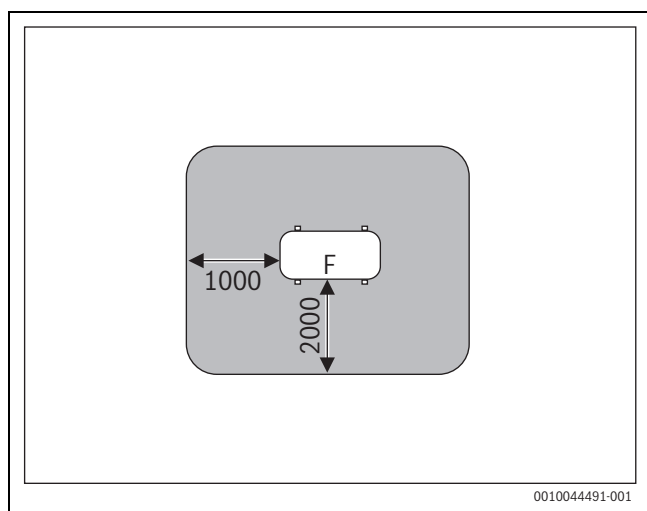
Zona di sicurezza per installazione a pavimento sul terreno di pertinenza o sul tetto - misure in mm
